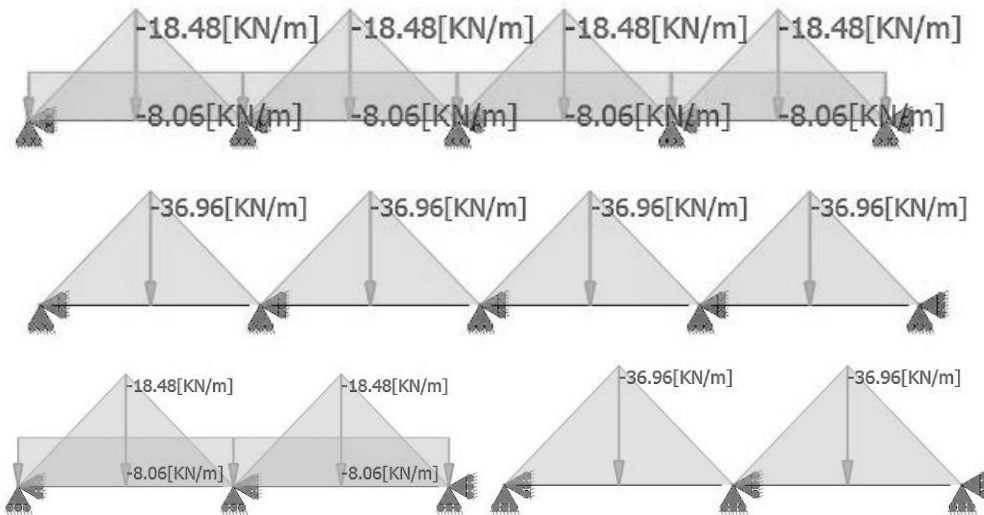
Esquema de carga en vista vigas de fundación cisterna
